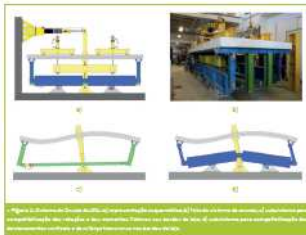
Sistema inovador de ensaio experimental para o comportamento de lajes fungiformes sujeitas a ações horizontais cíclicas. (a) Vista superior do sistema de ensaio; (b) Vista lateral do sistema de ensaio; (c) Detalhe da excrescência bi-rotulada que liga a laje ao pilar; (d) Detalhe do sistema mecânico passivo utilizado para controlar a rotação e o esforço transversal nos bordos opostos.
